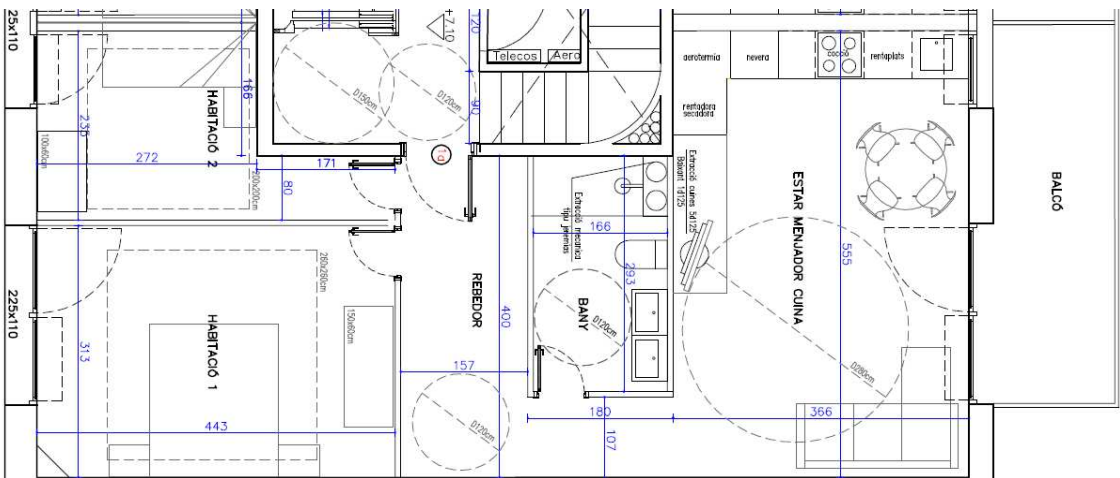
Planta pis tipus Proposta Arquitectura (Annex 3)
